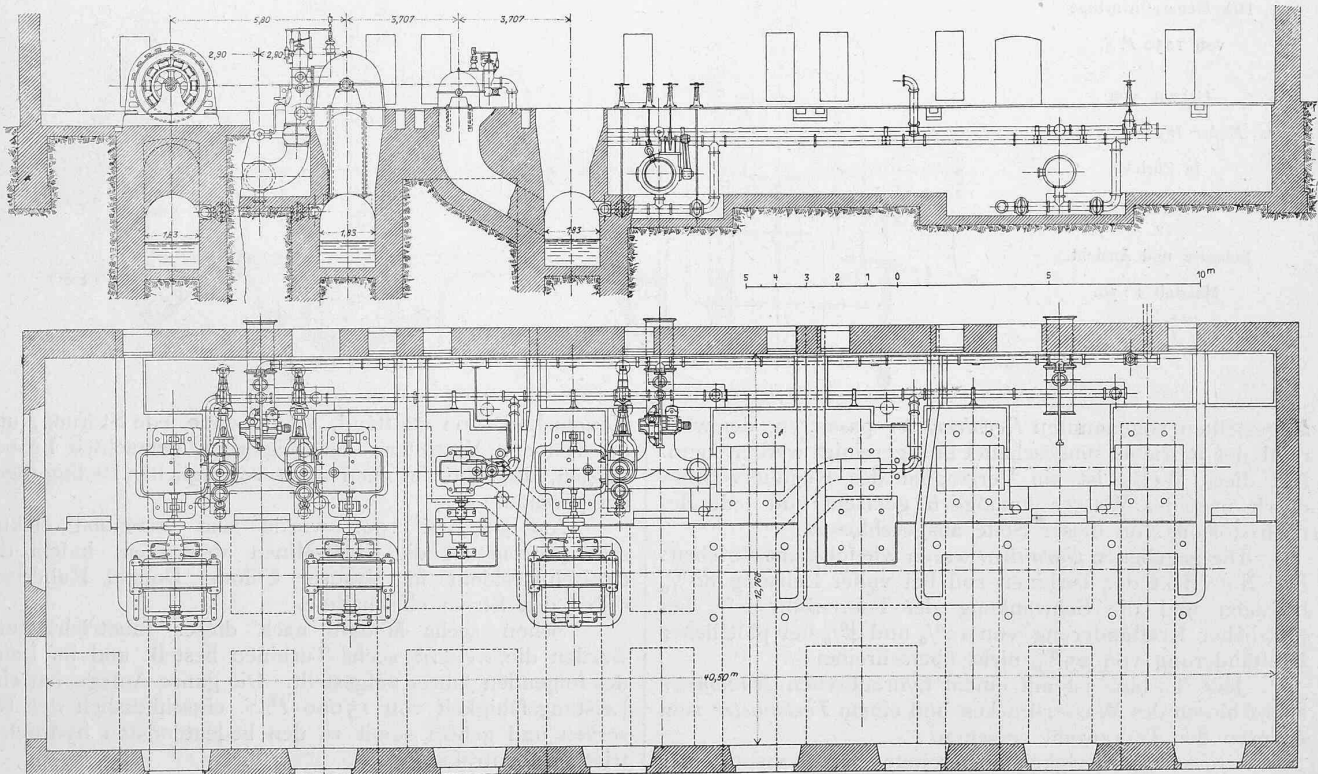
Grundriss und Längenschnitt des Maschinenhauses. — Masstab 1 : 225.
